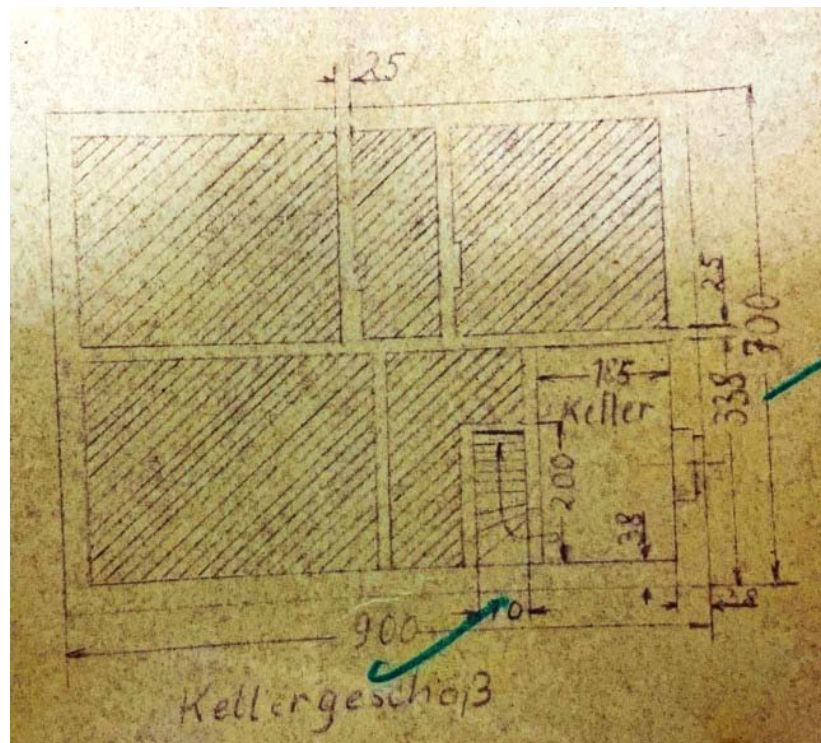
bauzeitlicher Plan – Grundriss Kellergeschoss des Einfamilienhauses
